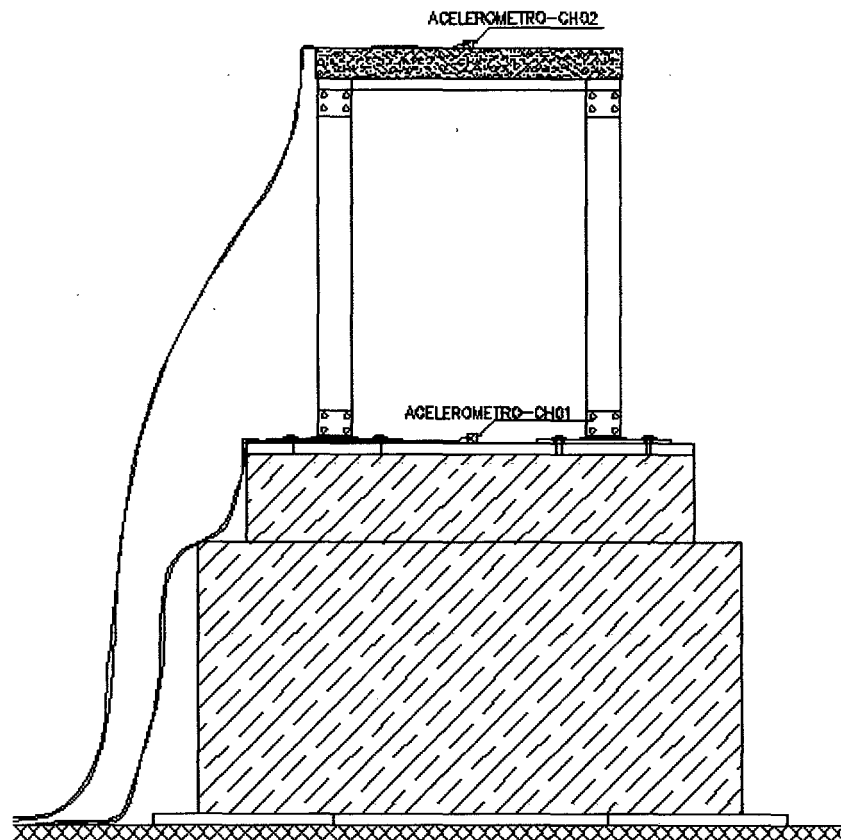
Sección B-B ubicación de sensores (dimensiones en metros)
